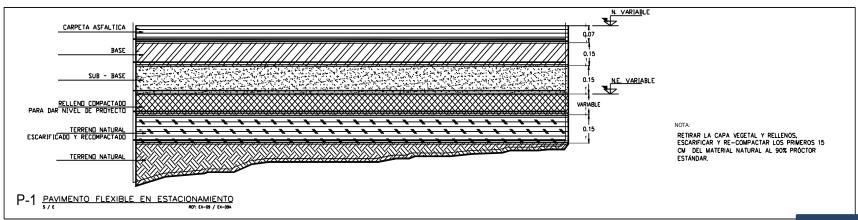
Plano Detalles de Terracerías, Referencia Plano: CPJ-EX 09F.DWG
